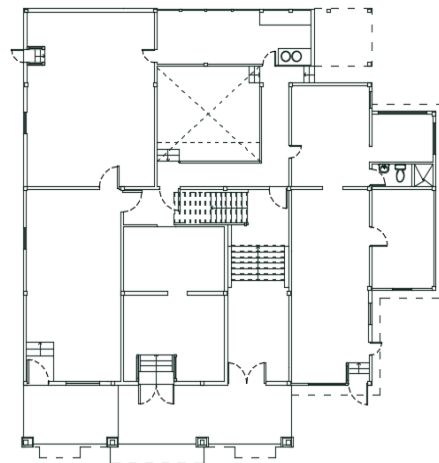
Plano arquitectónico de planta baja de la Casa Metalli. (INPC, 2017)
